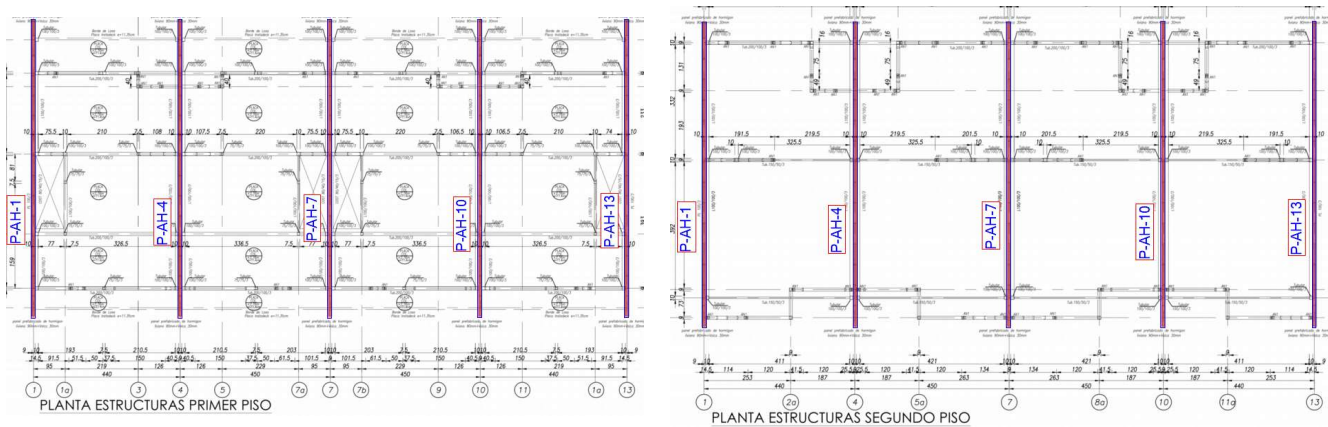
Planta cielo piso 1 y 2 notación de elementos Pier.
